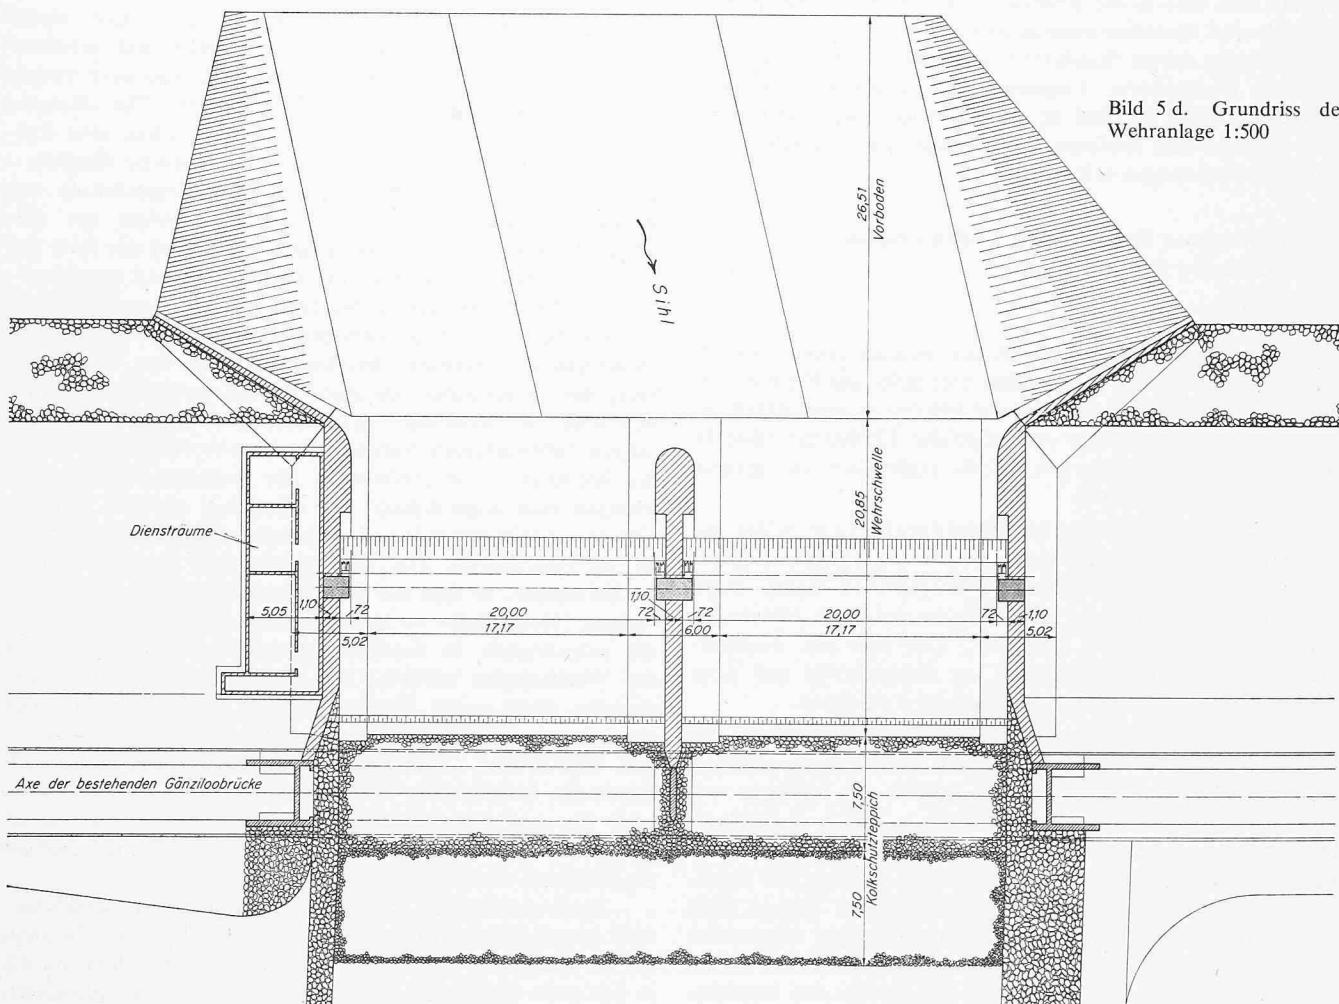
d. Grundriss der Wehranlage 1:500
